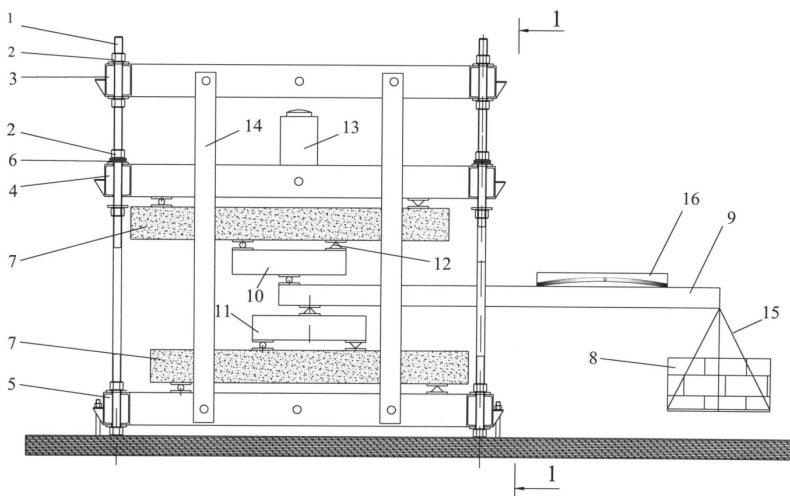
Установка для контроля прочности при проведении испытаний на поперечный изгиб железобетонных балок при кратковременных и длительных нагрузках [3-4], где: 1 – штанга; 2 – гайка; 3 – верхний ригель; 4 – средний ригель; 5 – нижний ригель; 6 – упорные подшипники; 7 – железобетонная балка (образец); 8 – груз; 9 – грузовая консоль; 10 – верхняя траверса; 11 – нижняя траверса; 12 – центрирующая опора; 13 – гидравлический домкрат; 14 – страховочная рейка; 15 – грузовая платформа; 16 – уровень.
